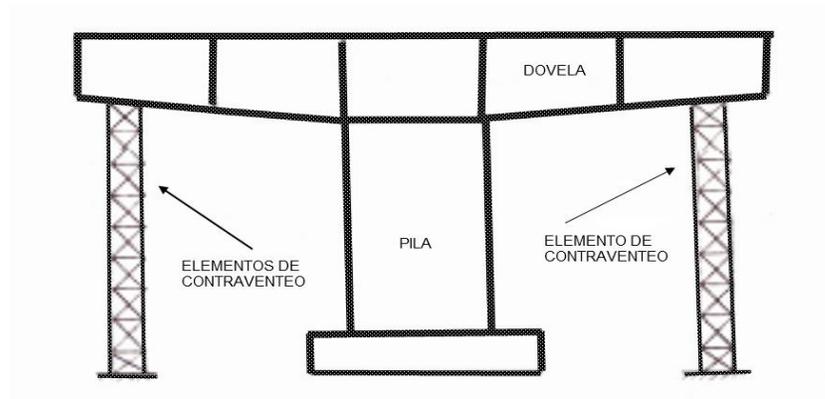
Elementos en doble voladizo con estructuras de contraventeo, para permitir simetría en las cargas durante el proceso de construcción
